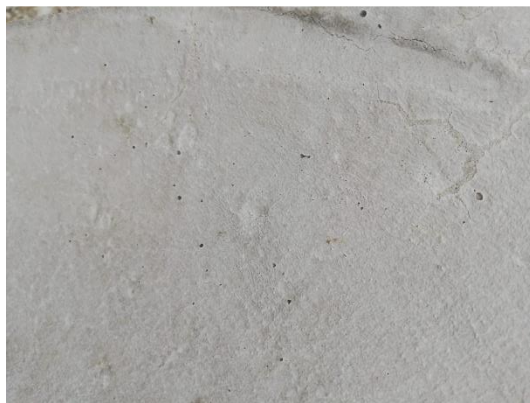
Acercamiento losa de concreto reforzado con malla electrosoldada, descascamiento radial de la superficie.
